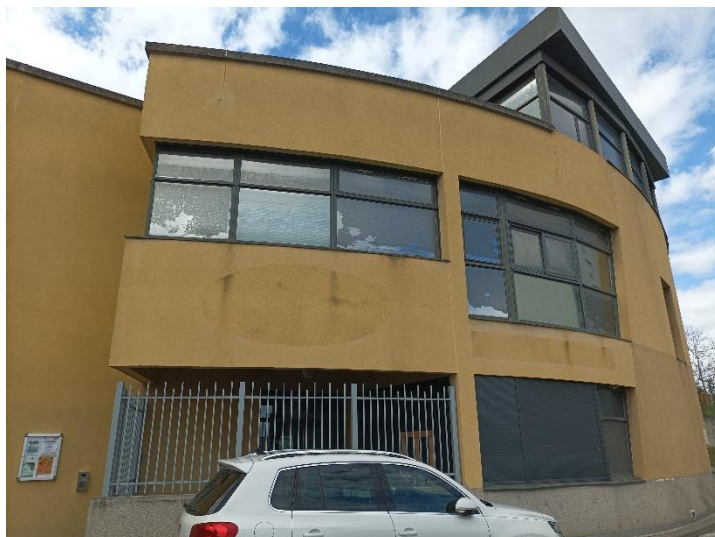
vue extérieur pleine Est du local, situé au 1er et 2eme étage du bâtiment
